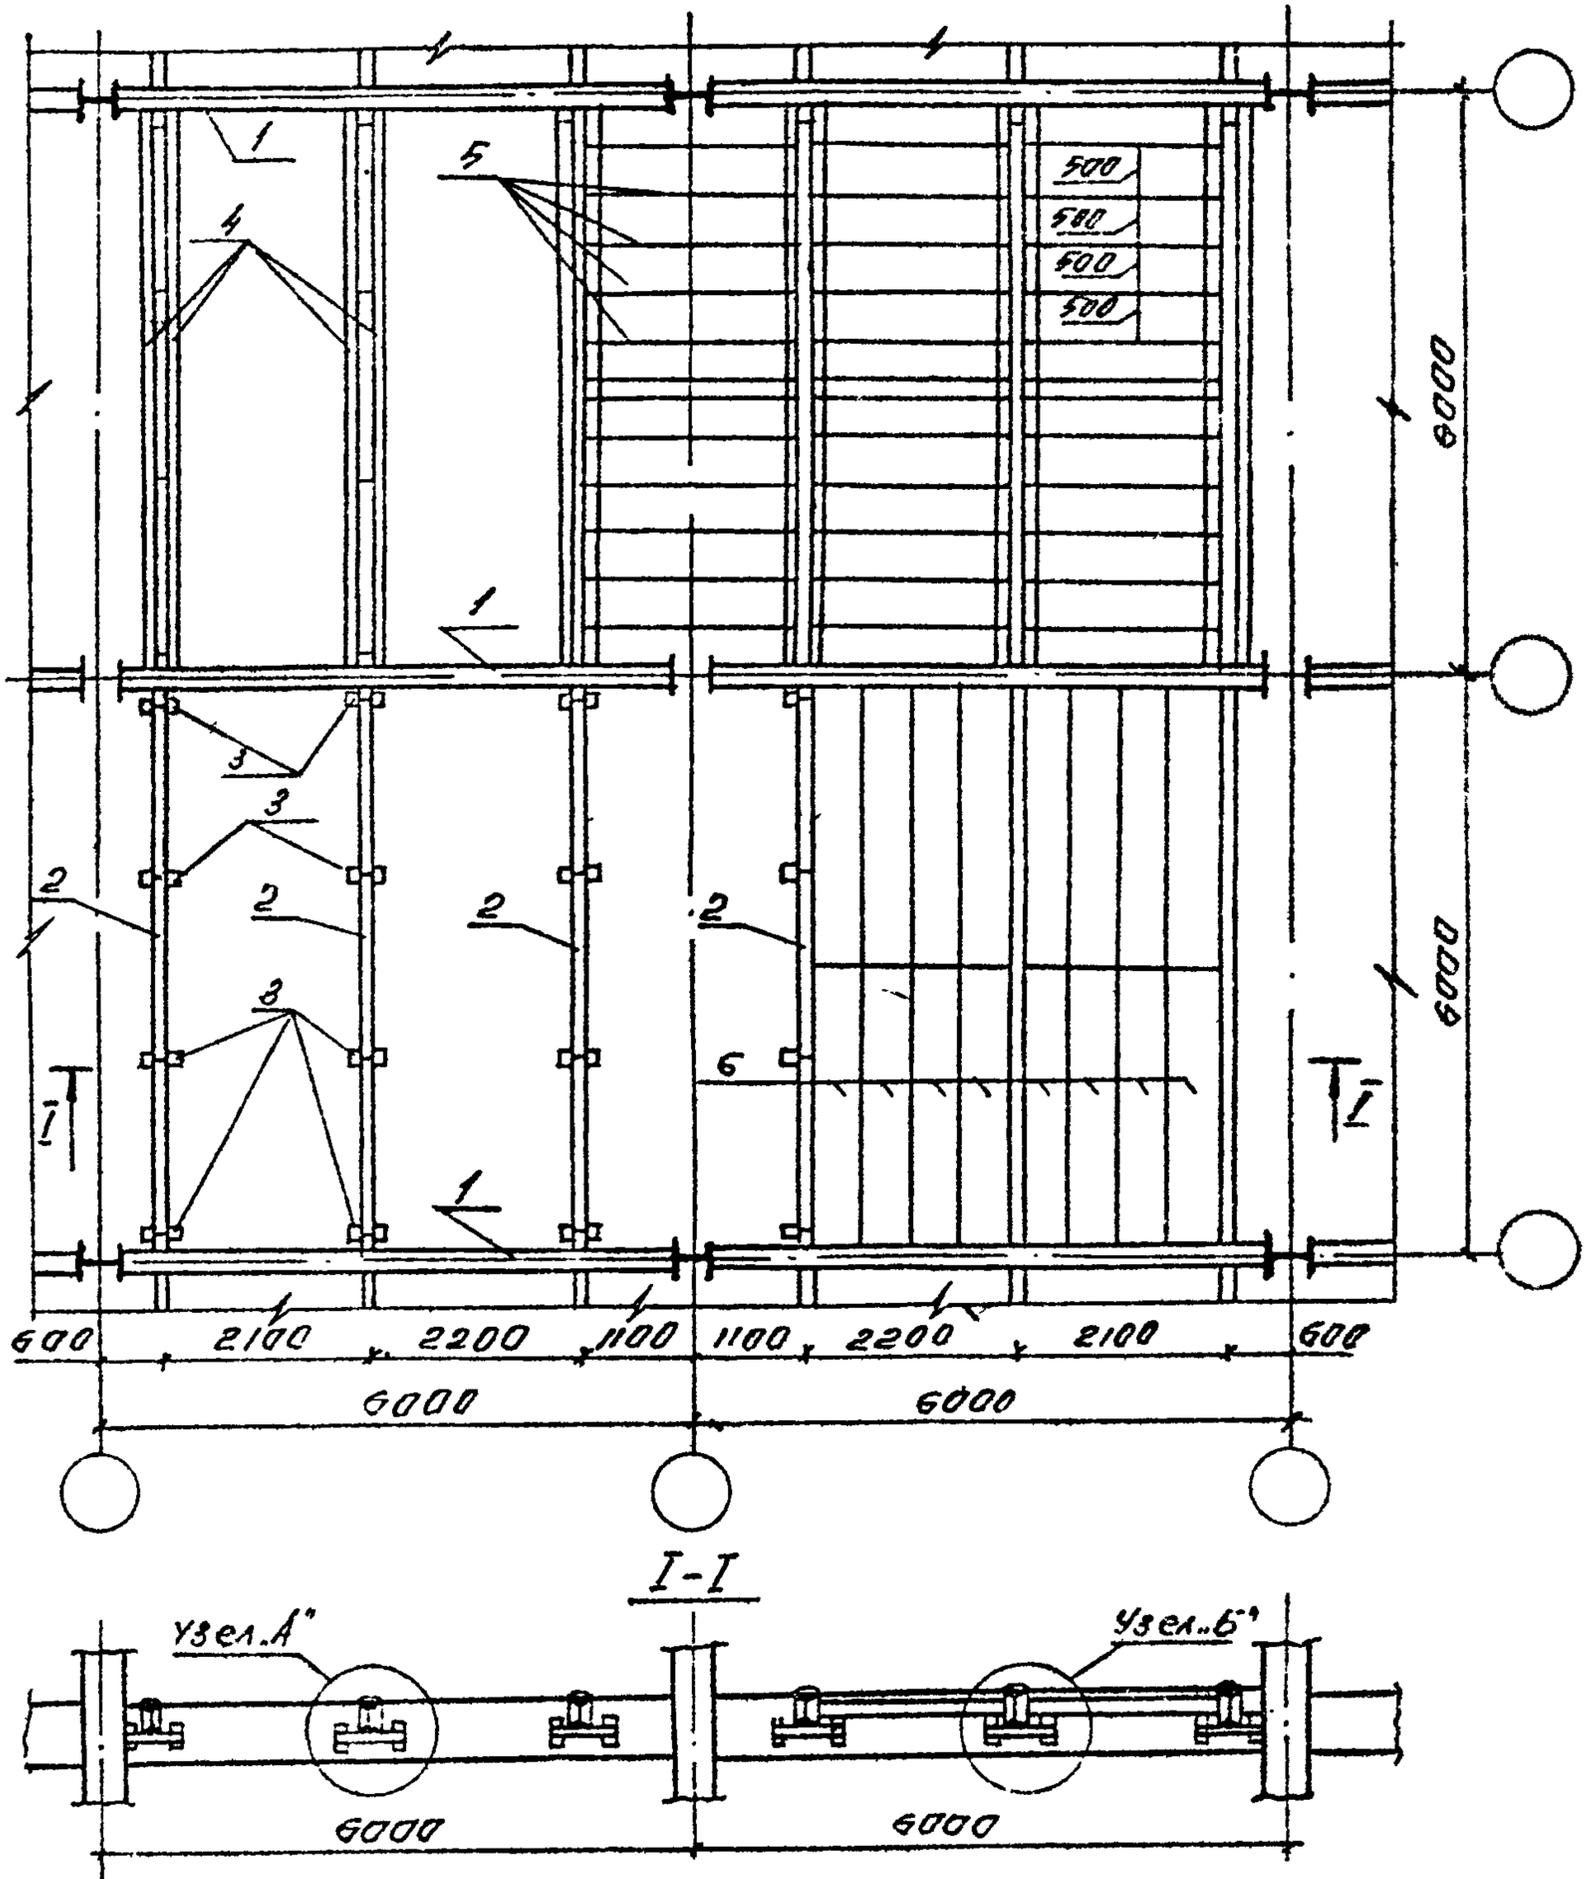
Монтажная схема металлических балок перекрытия и план опалубки. Вариант по металлическим балкам перекрытия.
